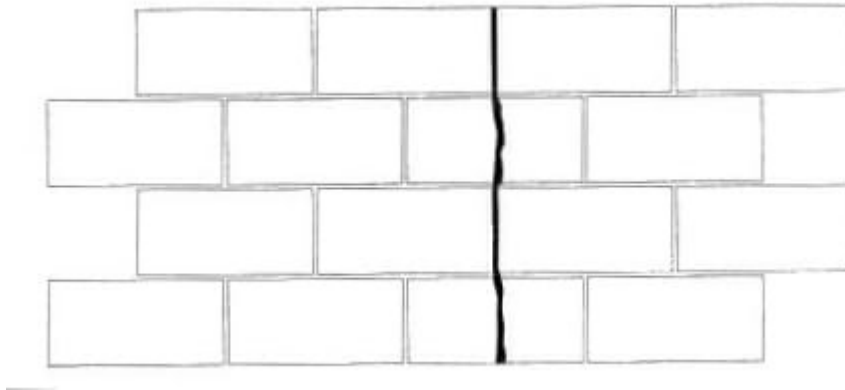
Fissura desenvolvida pela argamassa
